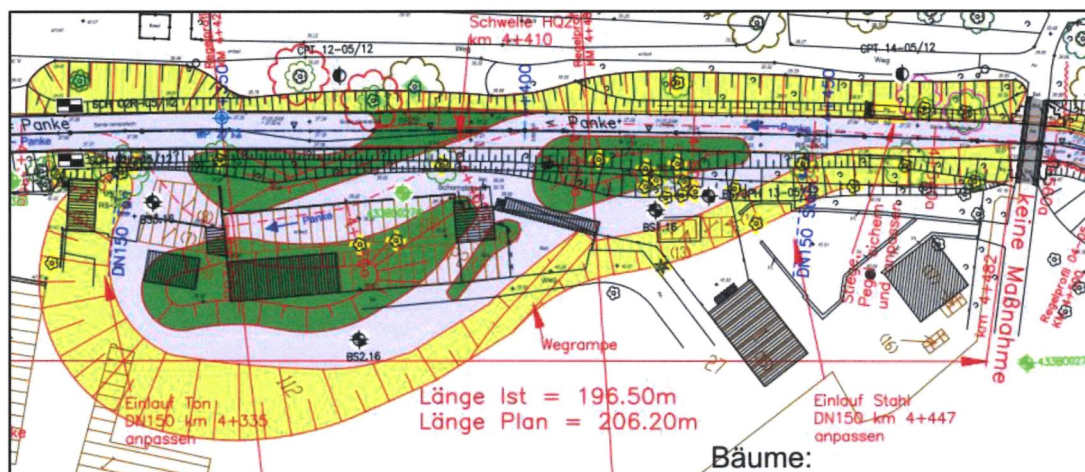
Lageplanausschnitt der Planungen am Revierstützpunkt
